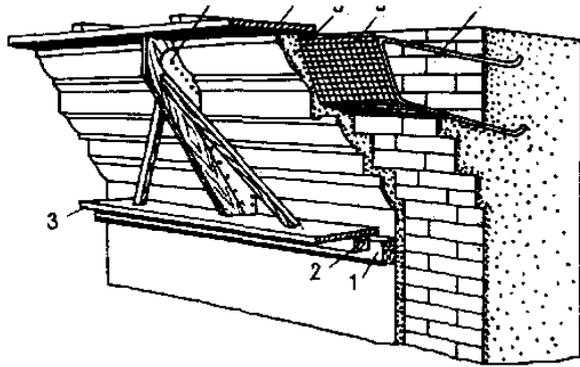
Вытягивание карниза : 1 - направляющие бруски; 2 - ползок; 3 - салазки; 4 - профильная доска; 5 - штукатурный намет; 6 - металлическая сетка; 7 - металлический каркас
